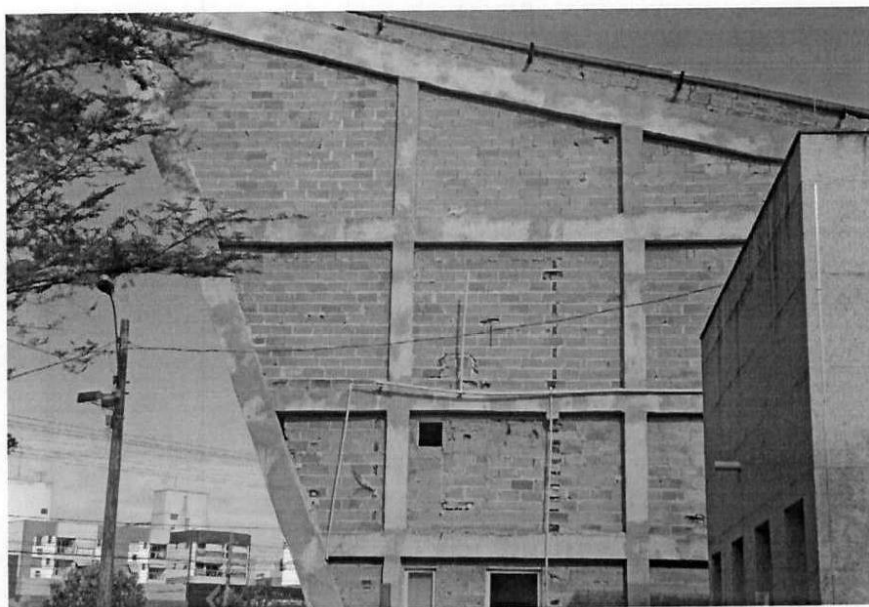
Fachada edificação - elementos estruturais em diversas dimensões, desalinhados e desaprumados
